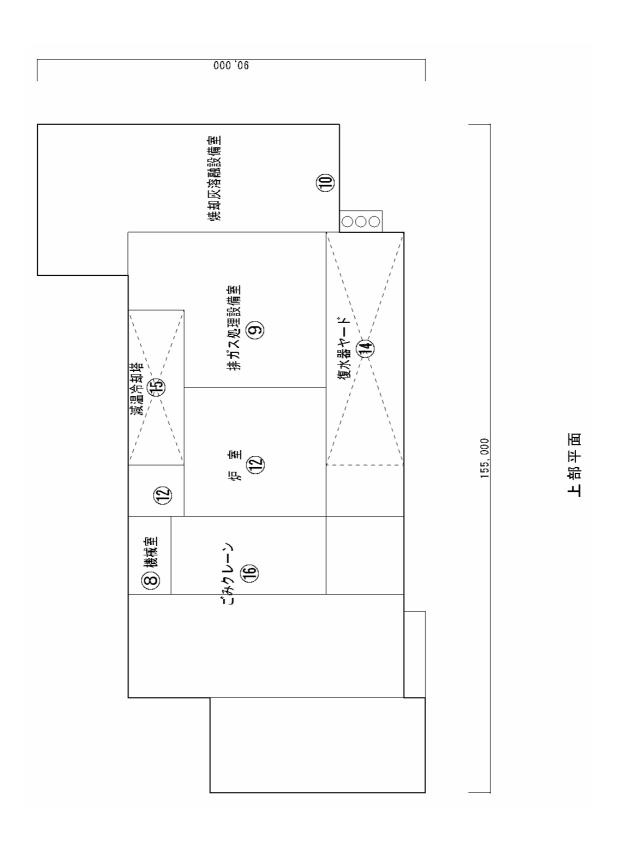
(1) 騒音・振動発生機器配置図(平面図)
